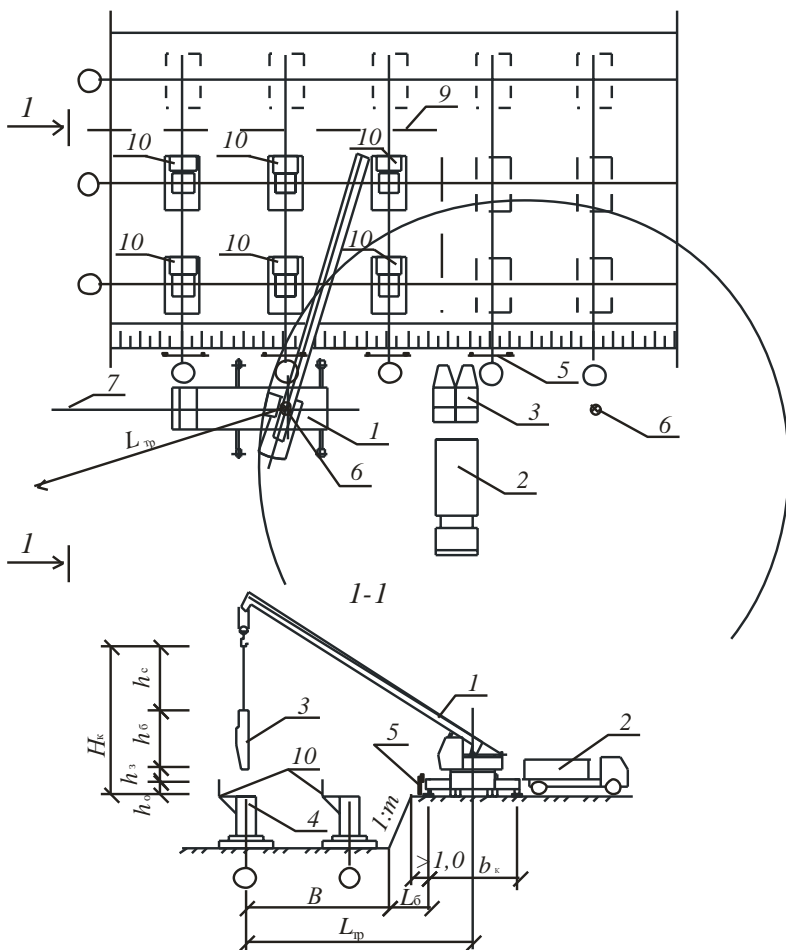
Схема бетонирования фундаментов с бермы котлована:
